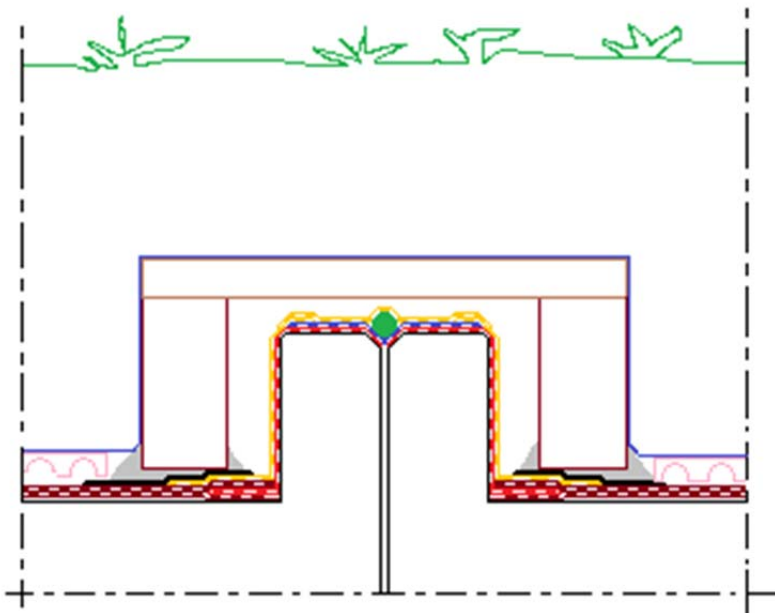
Cas du joint semi-enterré protégé par dalles - Terrasse jardin
